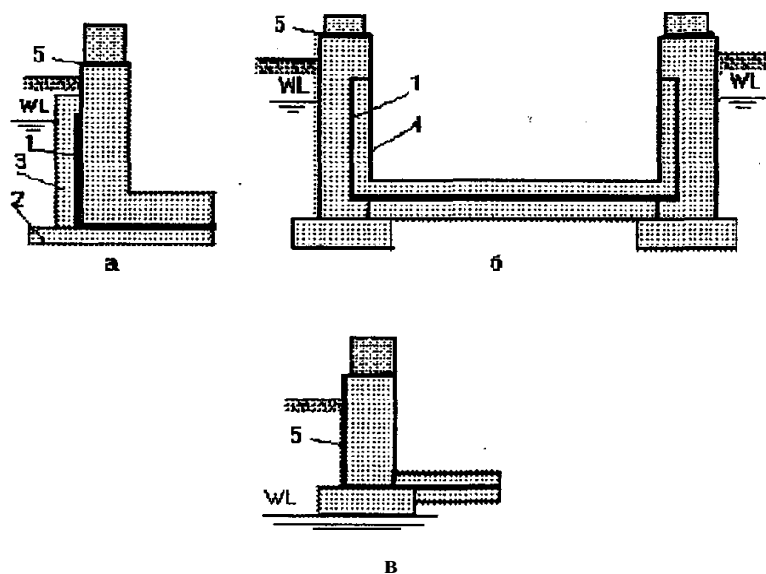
Схемы гидроизоляции: а - наружная противонапорная; б - внутренняя противонапорная; в - гидроизоляция для защиты только от капиллярной влаги: 1 - противонапорная изоляция; 2 - бетонная подготовка; 3 - защитная стенка; 4 - кессон; 5 - противокапиллярная изоляция
